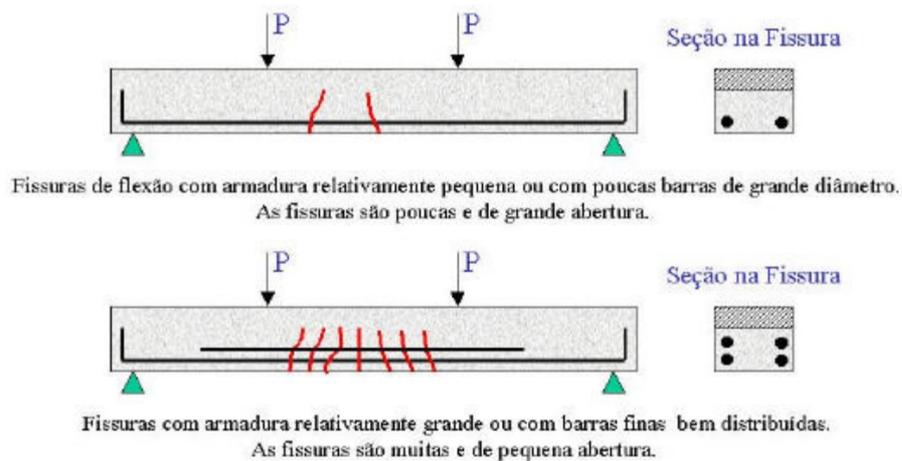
Fissurações típicas em vigas solicitadas à flexão.
